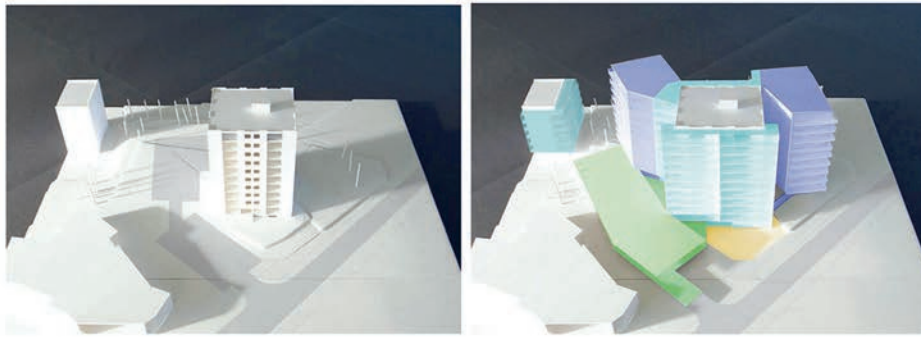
Elephant and Castle, Londra – Colville Estate, Londra.
